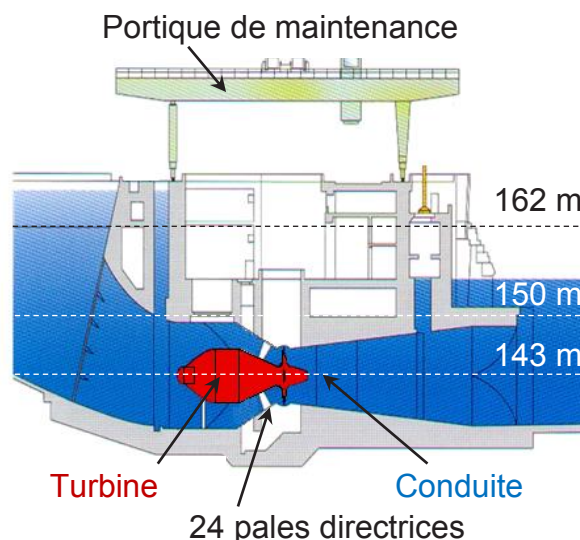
Schéma en coupe d'une conduite sur l'aménagement de Pierre-Bénite
